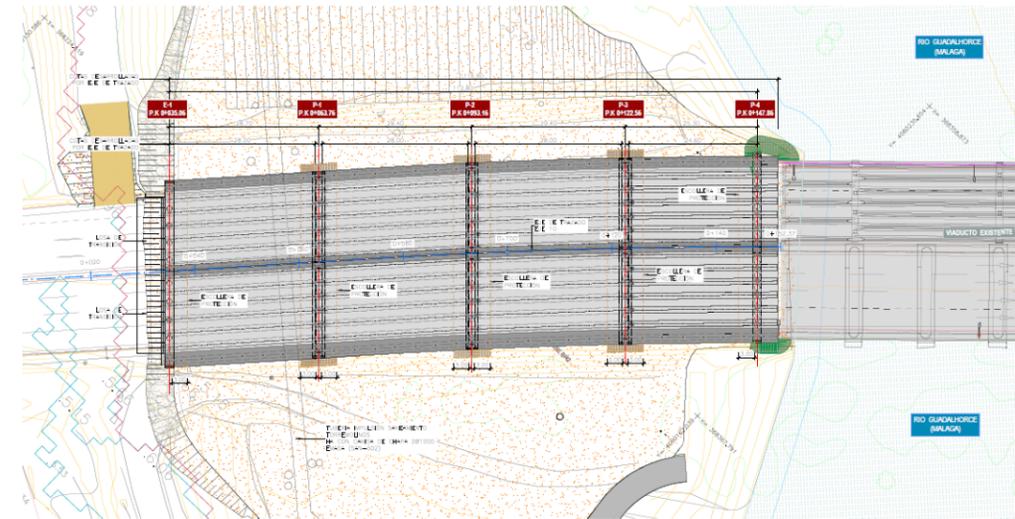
Vista en planta de la Ampliación del puente de la autovía MA-21
